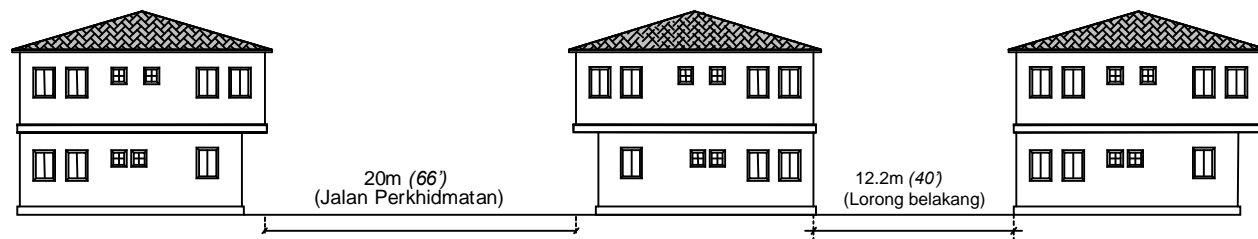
Profil Anjakan Bangunan Bagi Kilang Jenis Sesebuah dan Berkembar
